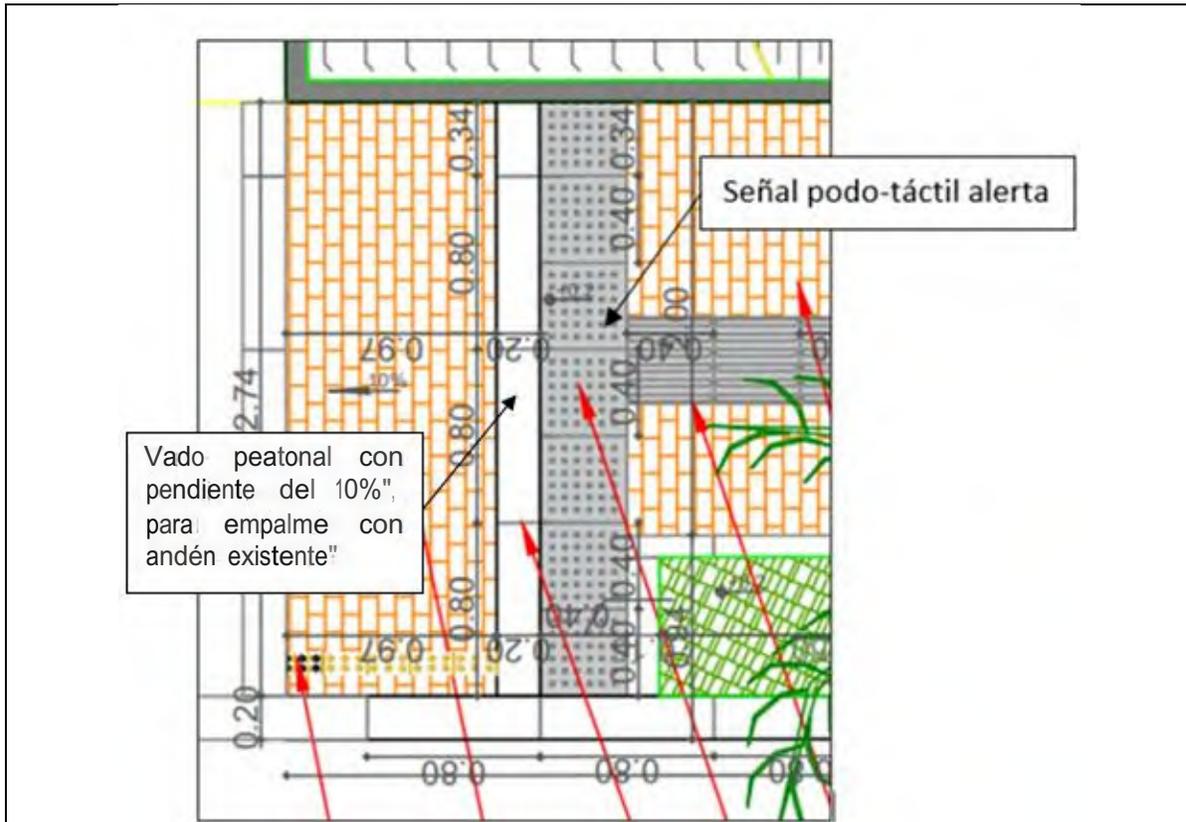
Detalle de la planta de diseño contenida en el Plano 2 / 2
